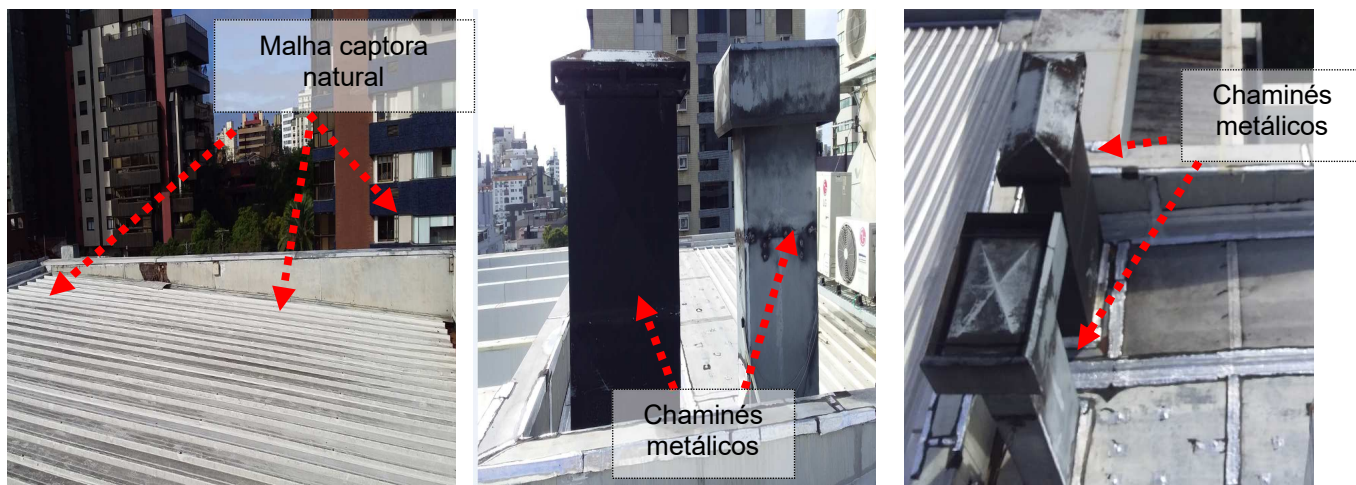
, 10 e 11: SPDA existente na cobertura da edificação.
